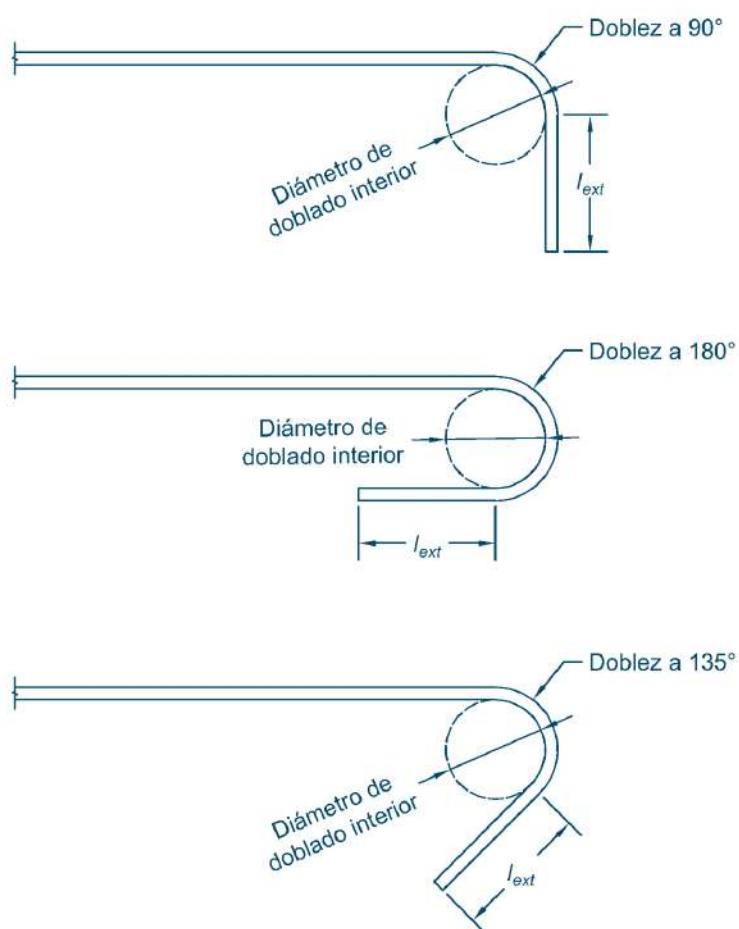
Geometría de ganchos estándar para refuerzo transversal, estribos y espirales.
